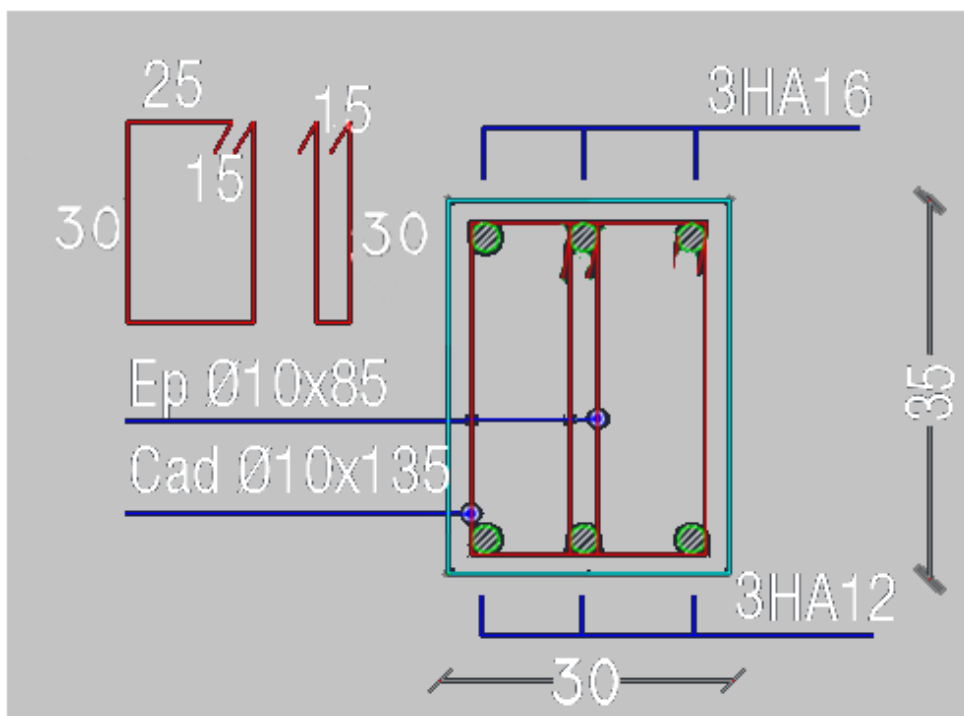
Ferrailage des poutres secondaires en travée de niveaux 5<sup>ème</sup> à 7<sup>ème</sup> étage.
